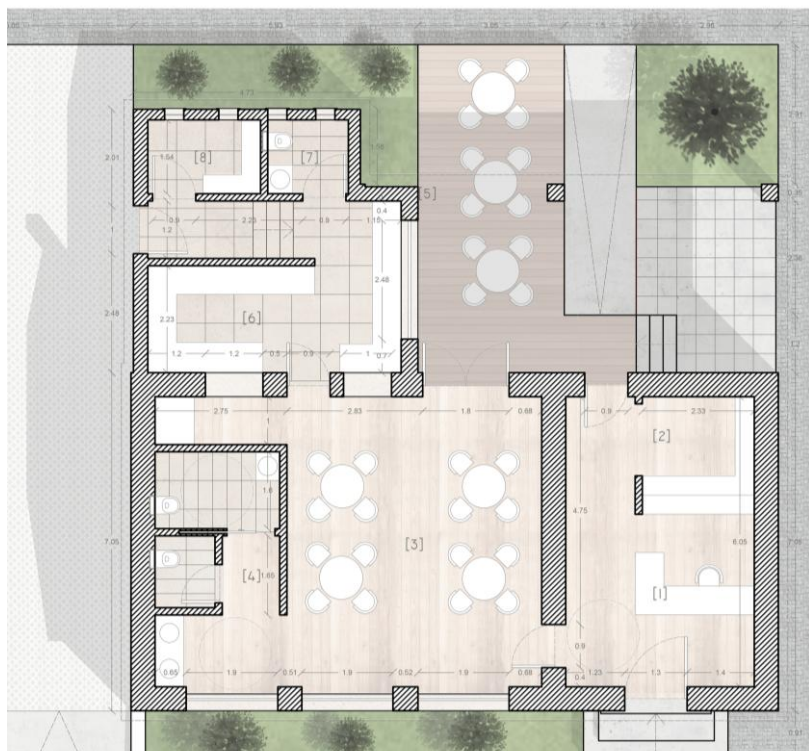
| Planta Piso Térreo Pré-existência (Proposto)
